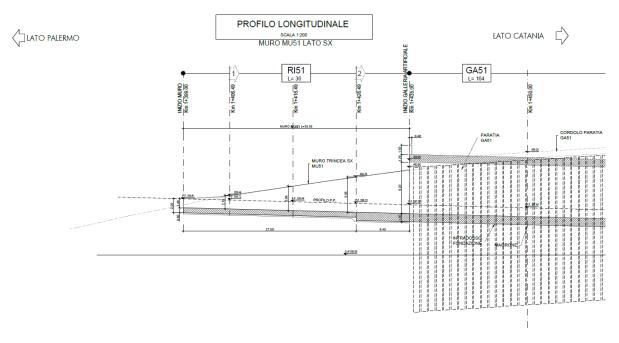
RI51: Muro a U MU51 – Prospetto lato sx.
